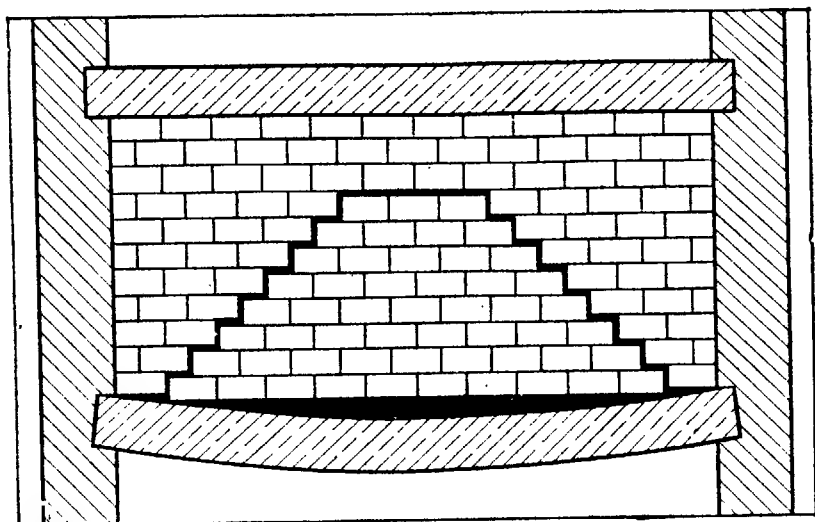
Образование трещин в ненесущих кирпичных перегородках из-за прогибов железобетонных перекрытий. Выше трещины образуется опорный свод — подпорка. Если перекрытие над стеной также прогибается, то свод продавливается и образуется чисто диагональная трещина. При известных условиях это приводит к образованию вертикальных сдвиговых трещин на боковых примыканиях стены
